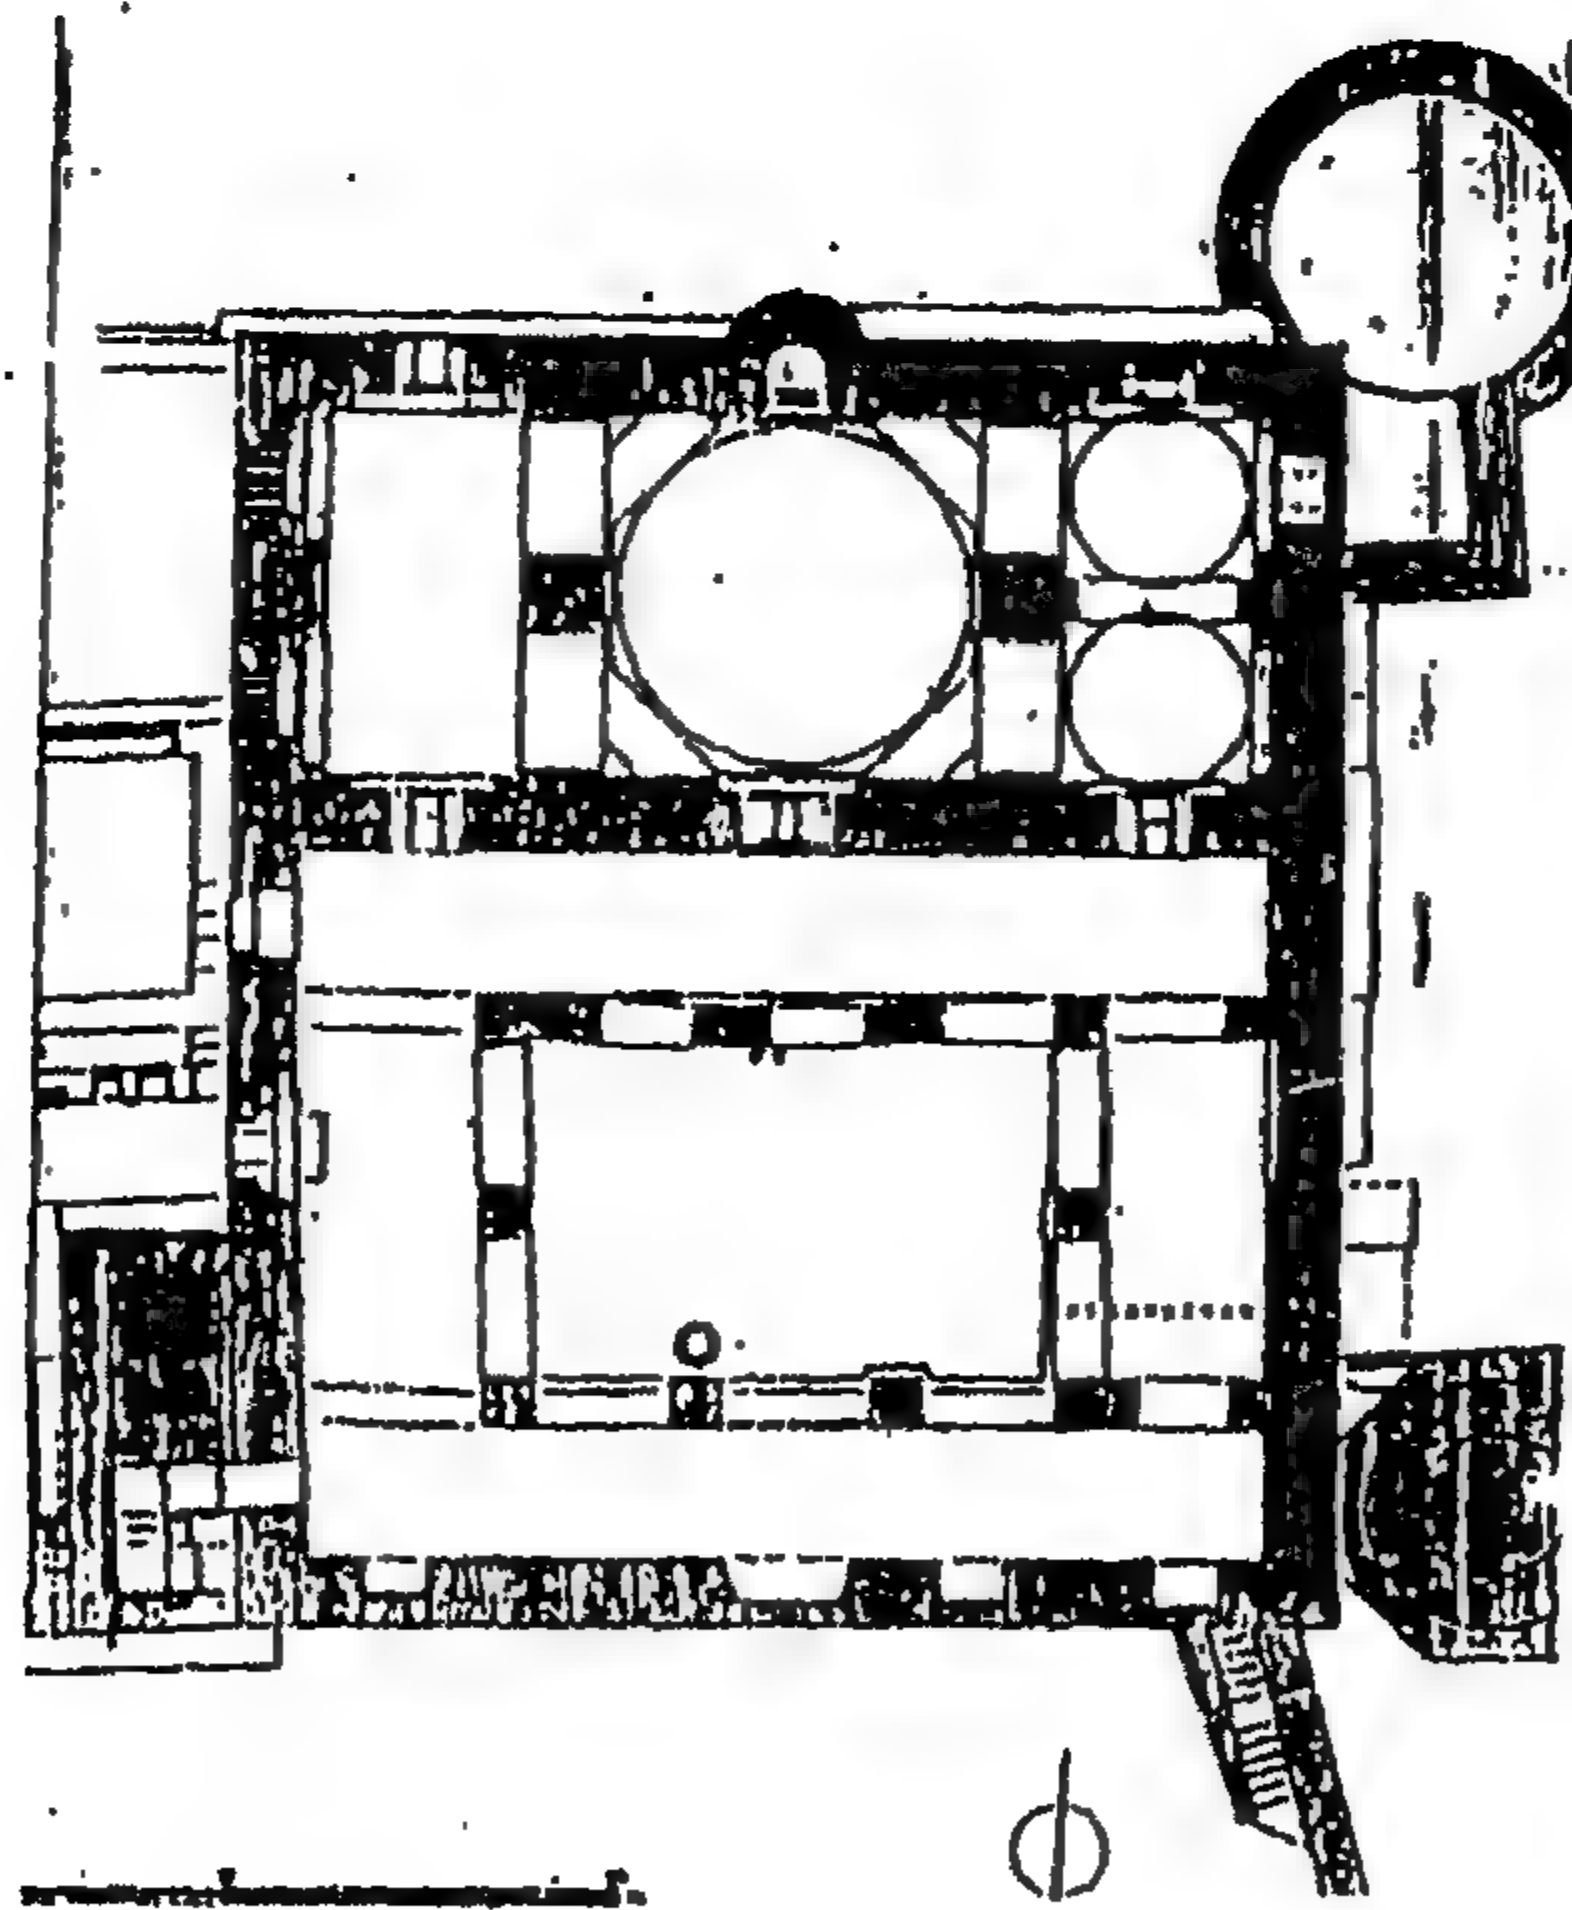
مسقط أفقي للبكيرية بصنعاء اليمن . (عن : سرجنت) .
